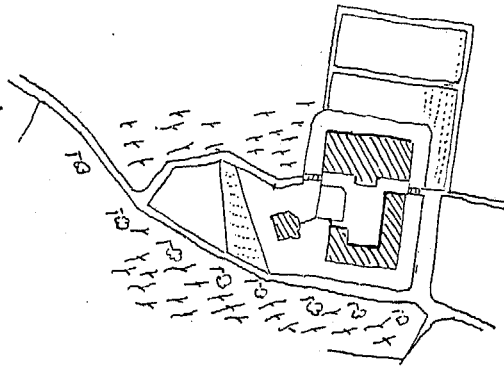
Günthersburg; Grundriss aus dem Jahre 1772.
